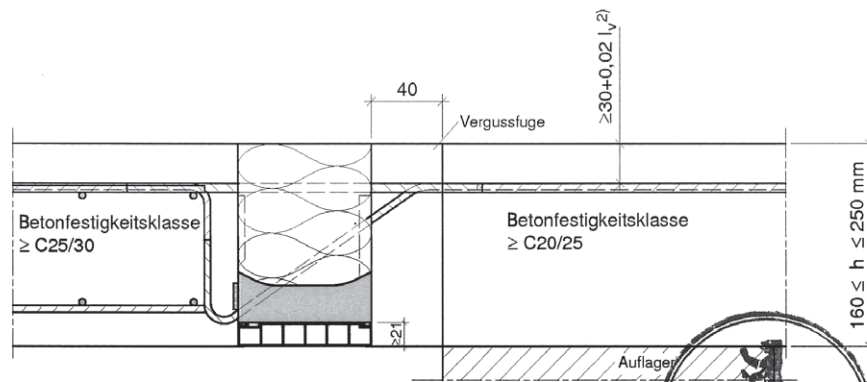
Beispiel Schöck Isokorb Typ RK-240 in eingebautem Zustand mit Vergussfuge
